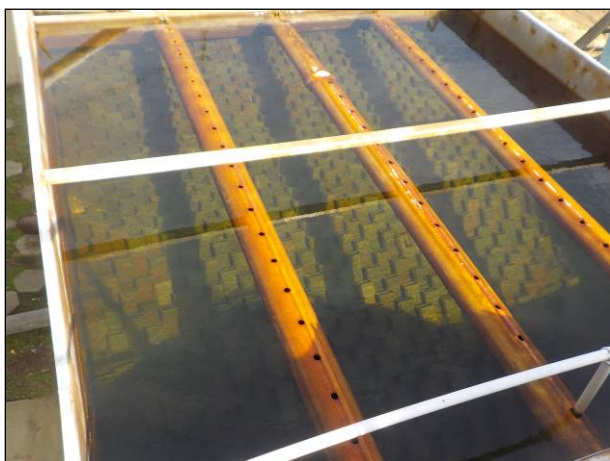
Vista do lado oposto de parte da ETA Passo de Torres, estrutura adequada, sem comprometimento da estrutura.
